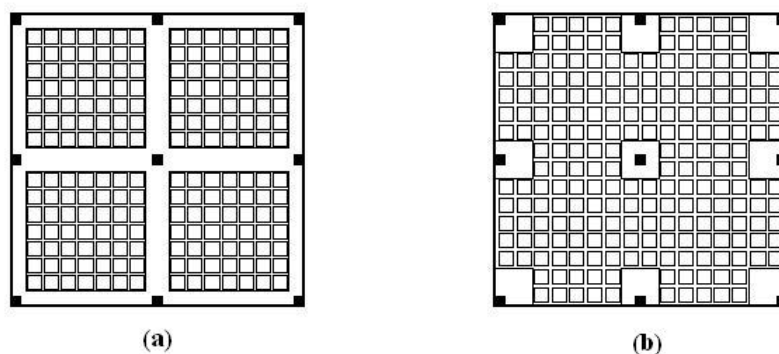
(a) Laje nervurada com vigas faixa; (b) Laje nervurada com engrossamento dos pilares. (adaptado de Emerick 2005)
